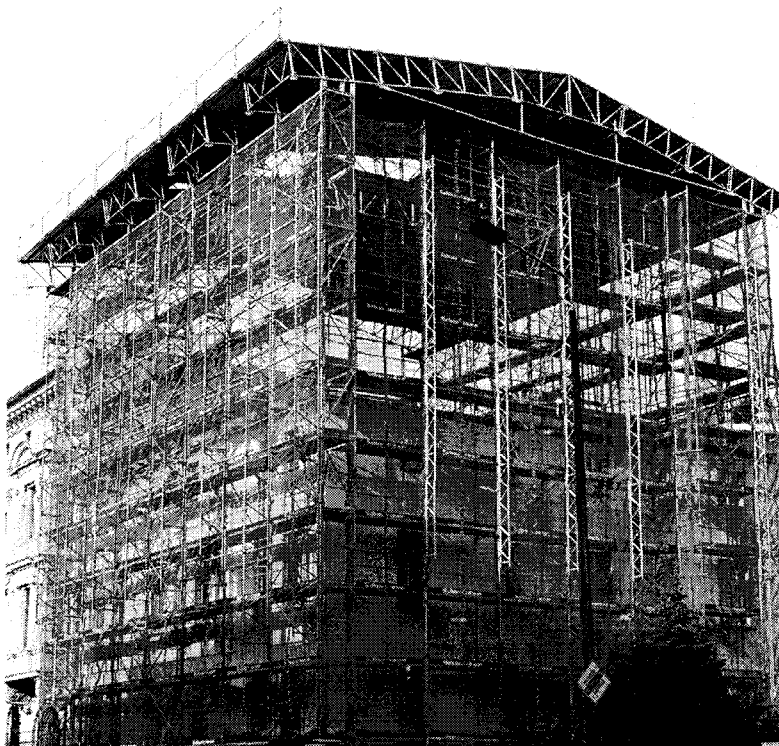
Ontwikkeling steigers van onbekleed naar een beklede en overkapte constructie
